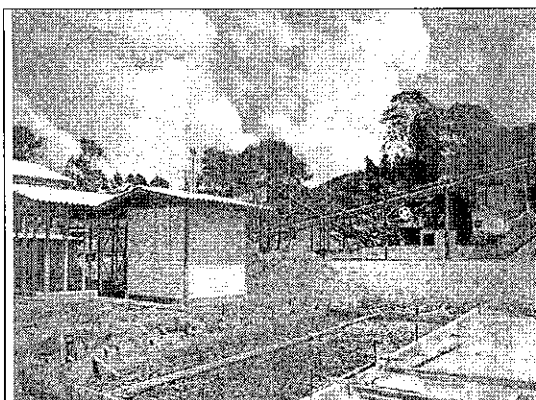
Canteiro de obras auxiliar, km 13, em implantação.
